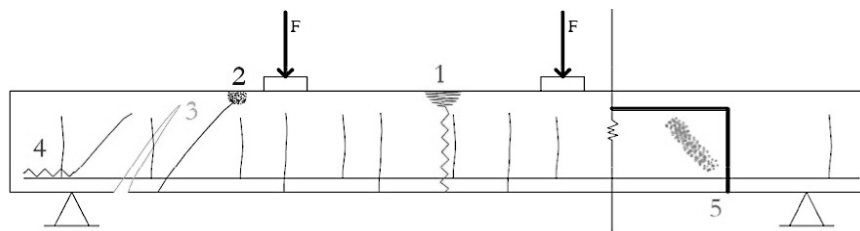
Formas de rotura em vigas de betão-armado.
